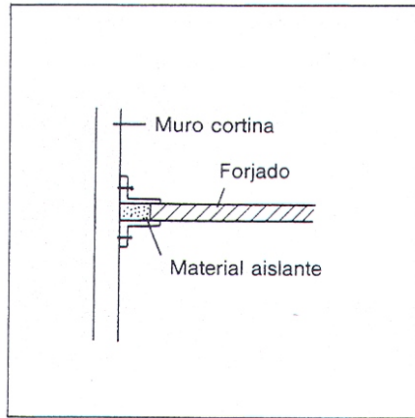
Cierre del hueco existente entre el muro cortina y el forjado.
